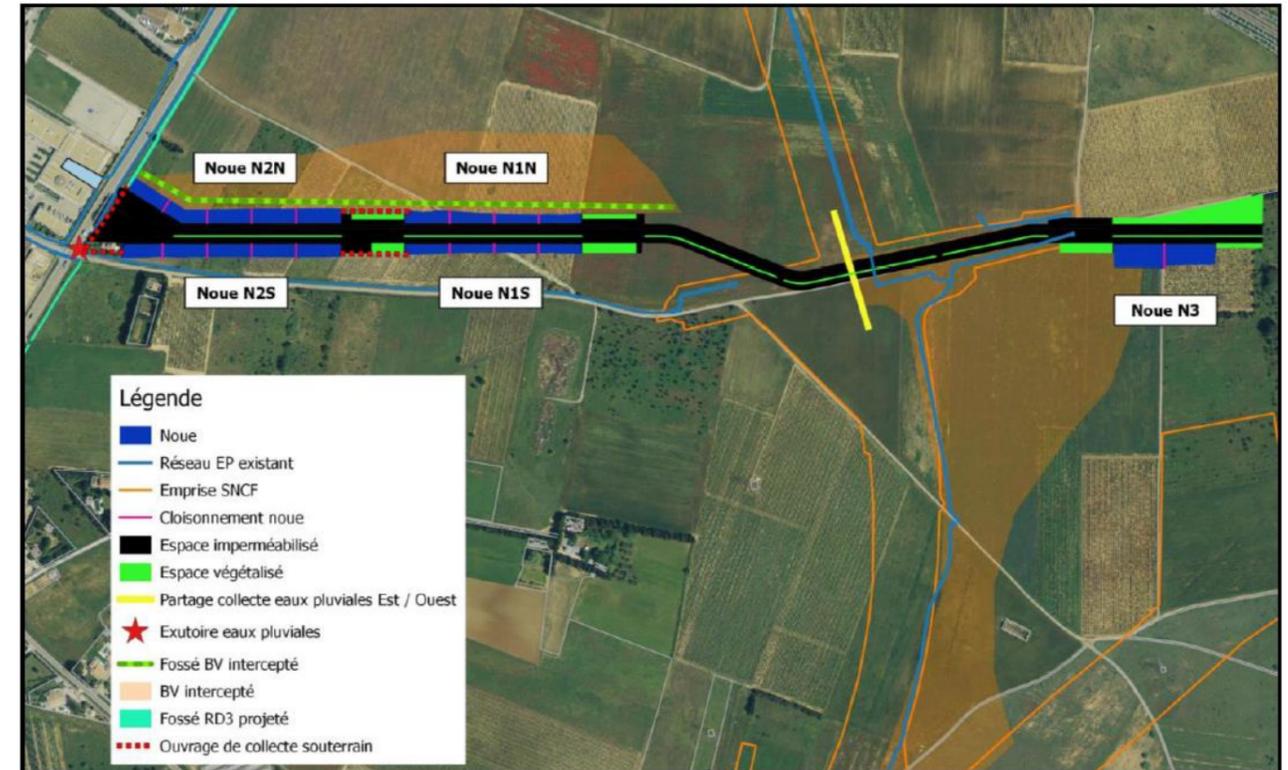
Ouvrages de gestion des eaux pluviales de l'avenue de la gare
